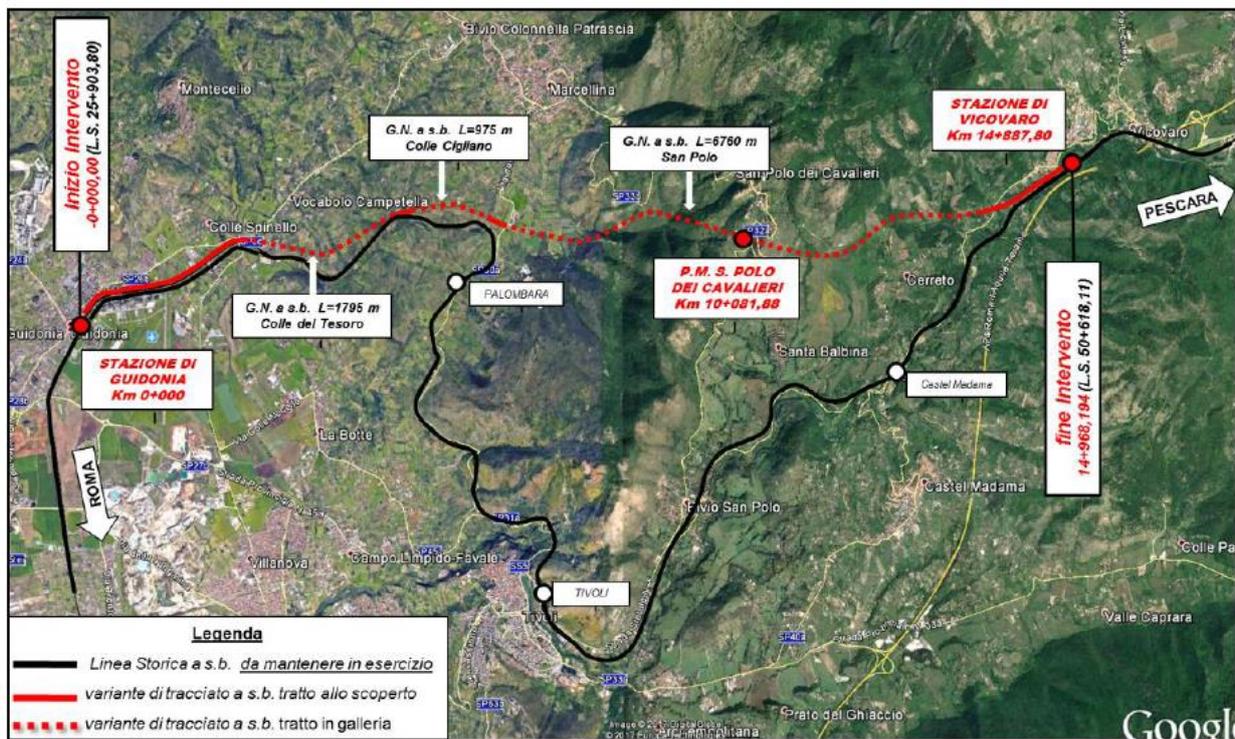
Progetto Preliminare 2008 – Intervento “Variante di Tivoli”
